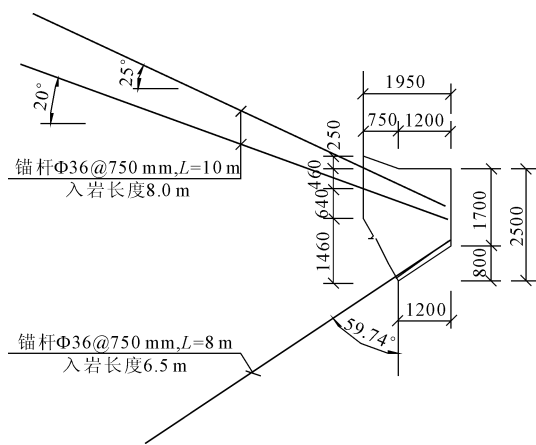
岩壁吊车梁锚杆布置(尺寸单位:mm)
